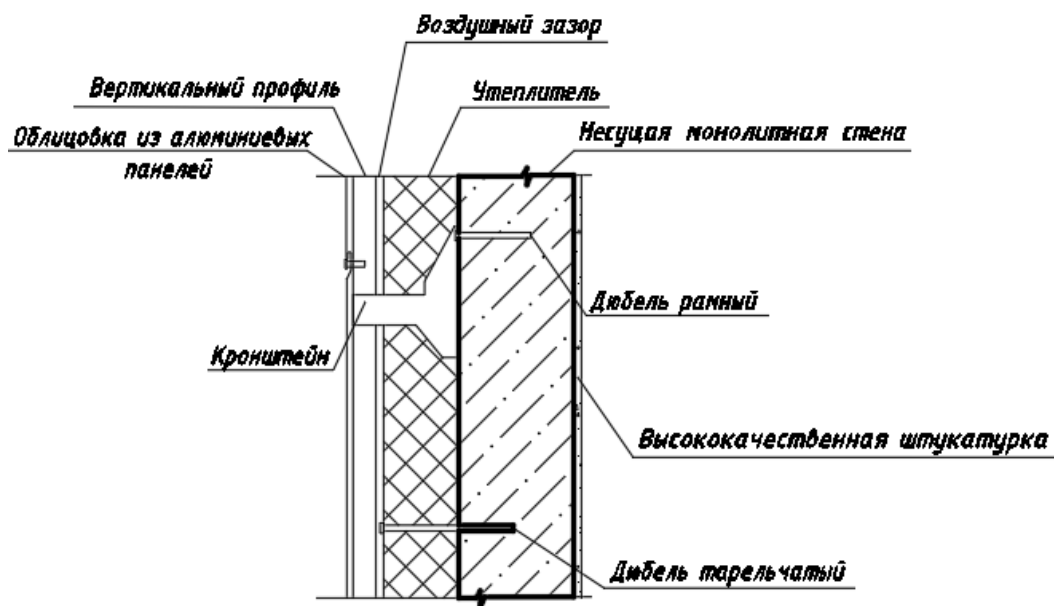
, пример ограждающей конструкции из тяжелого бетона с вентилируемым фасадом
